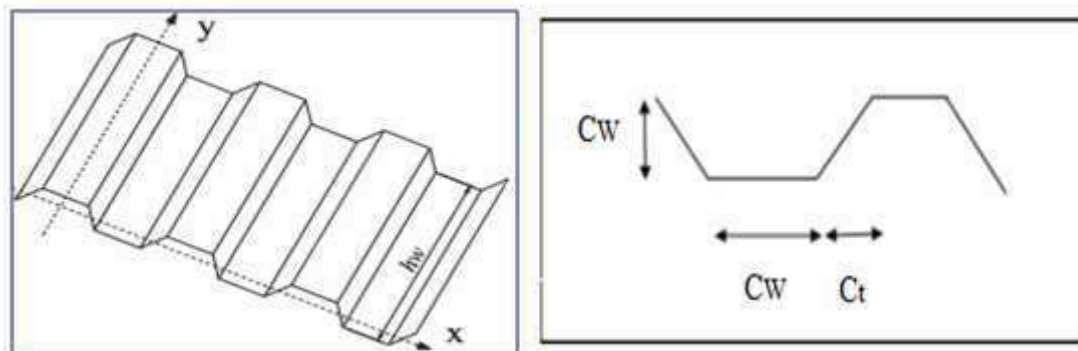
Présentation des sections transversales de la poutre à âme trapézoïdale.
